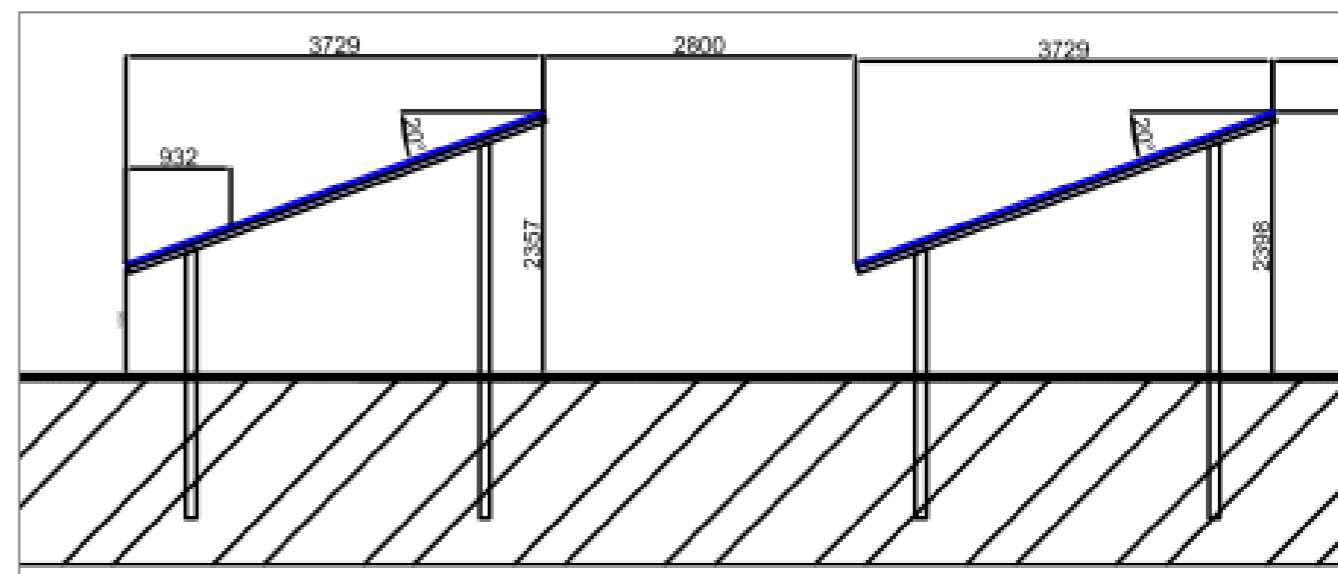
Schéma de l'agencement des tables d'assemblage (source : Serfim EnR)
